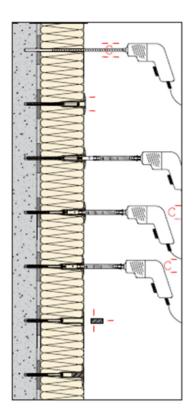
Colocación aislamiento con fijación ejotherm STR U 2G
